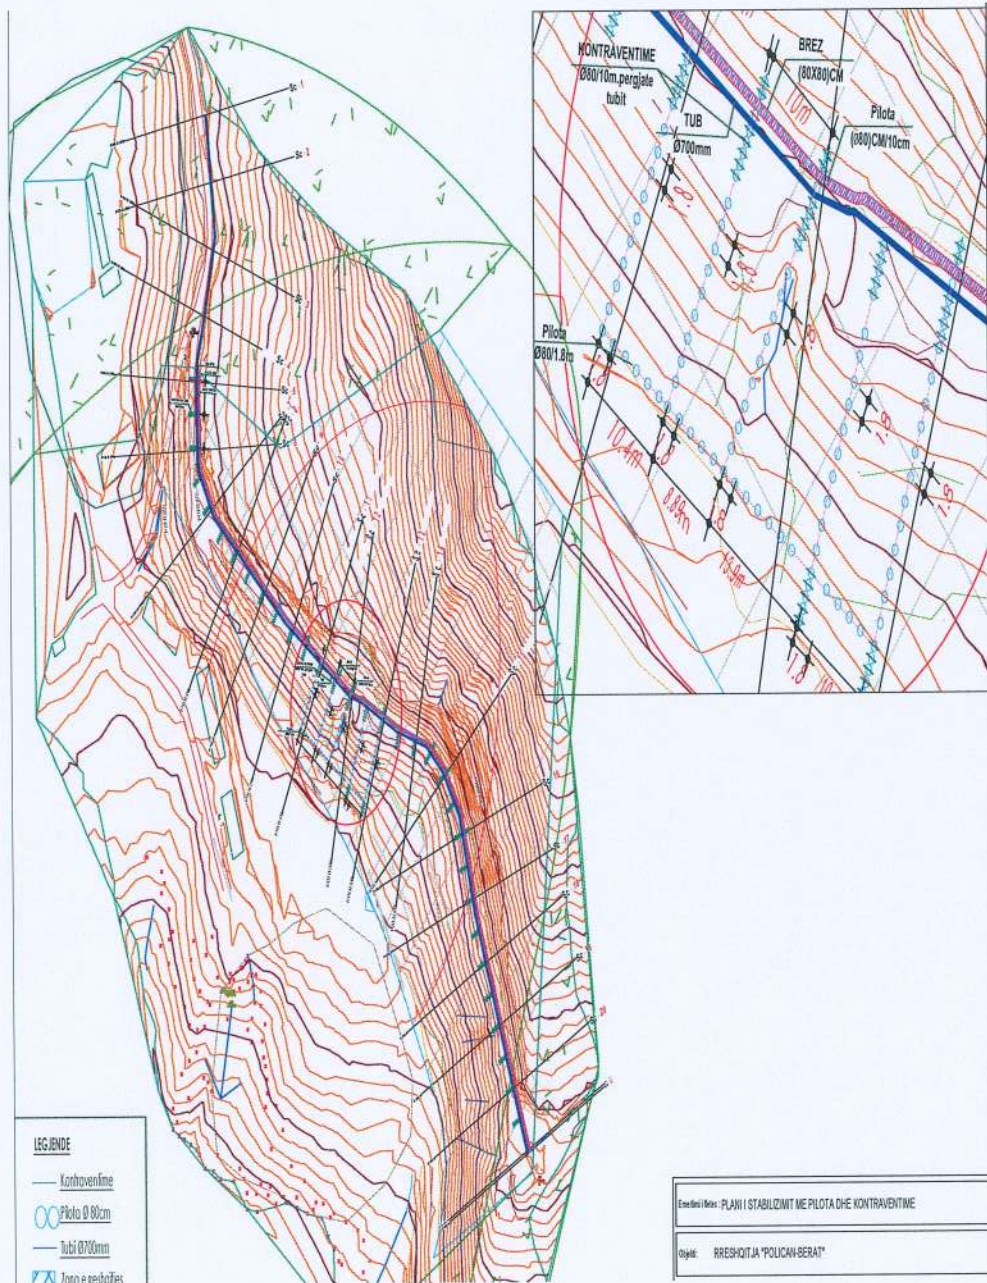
Planimetria, Varianti 2 i nderhyrjes.
